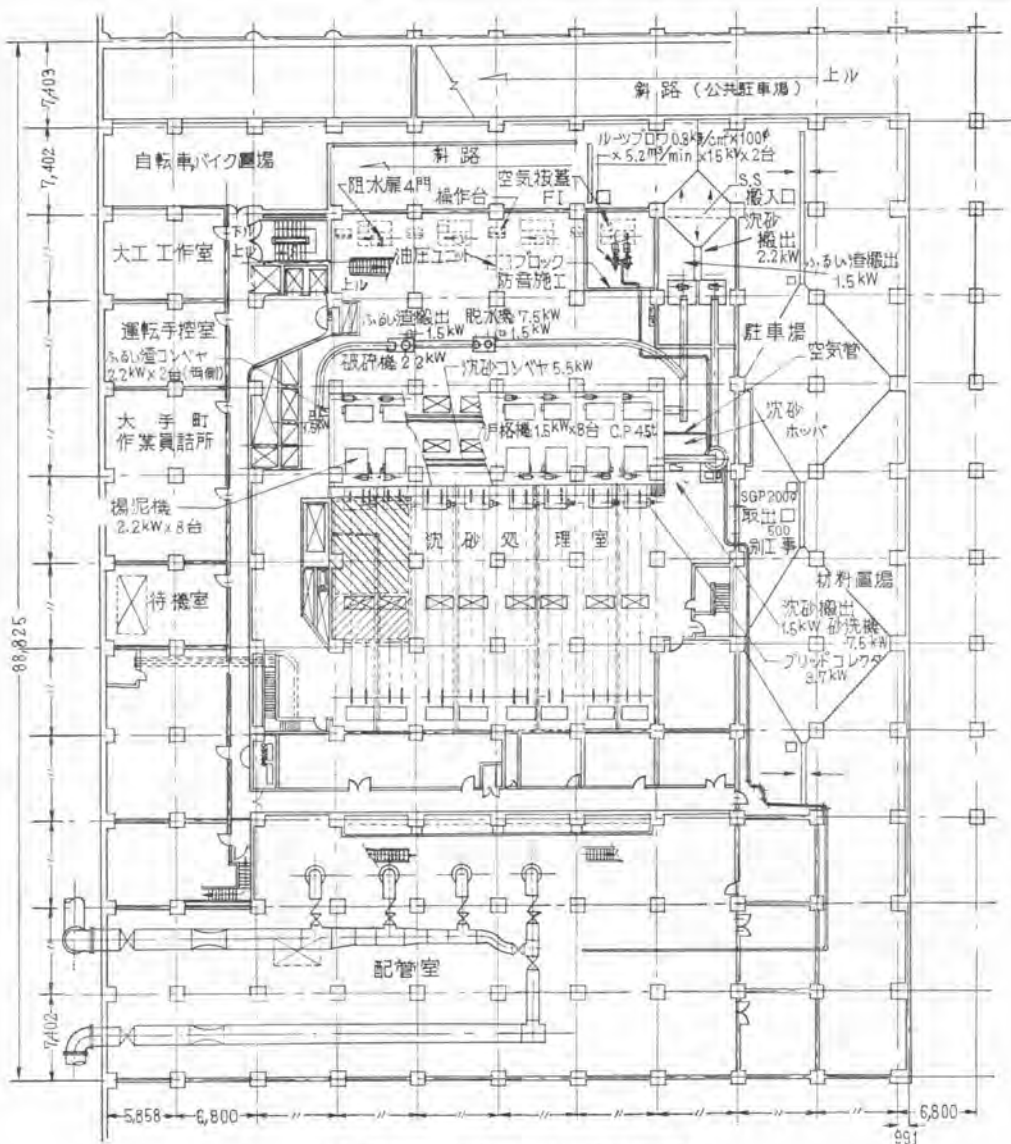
東京都下水道局銭瓶ポンプ場設備配置図
